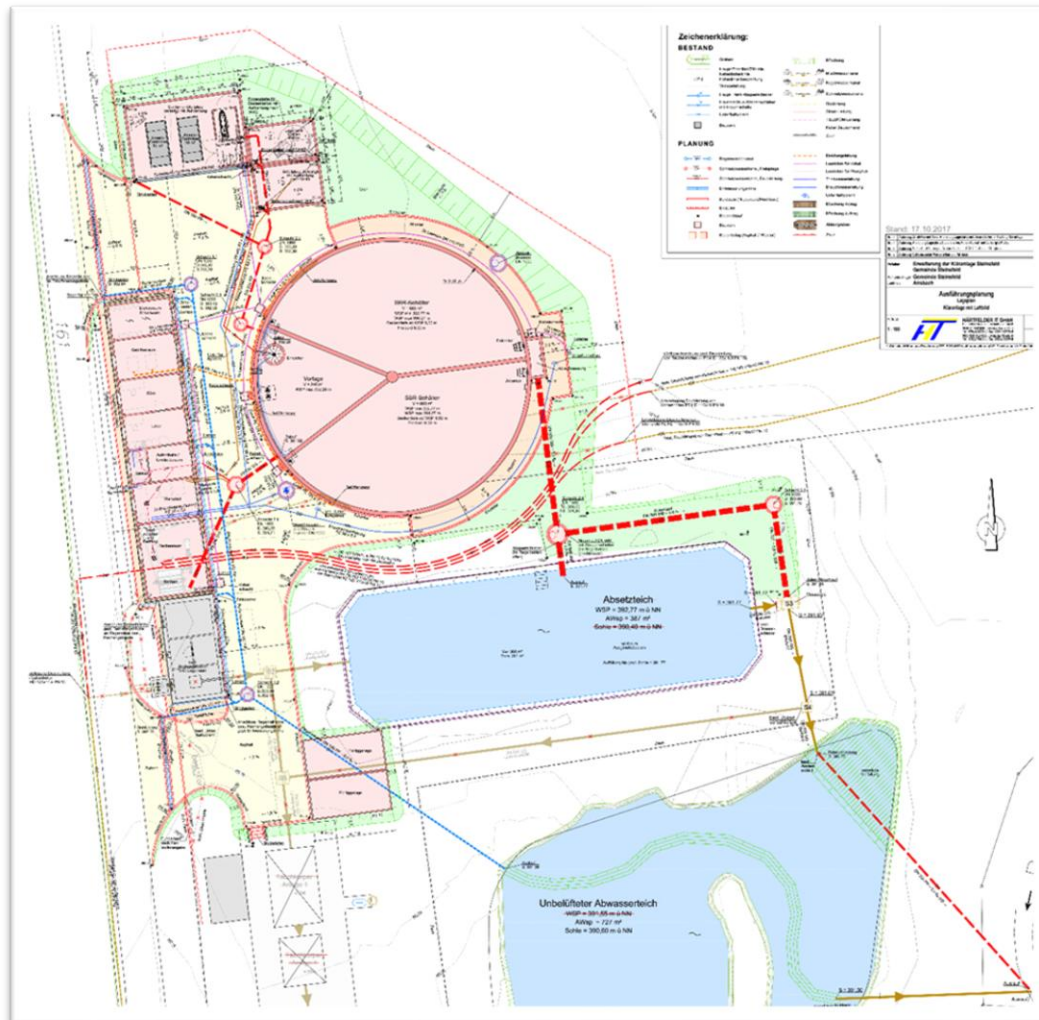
Kläranlage Steinsfeld – Lageplan
